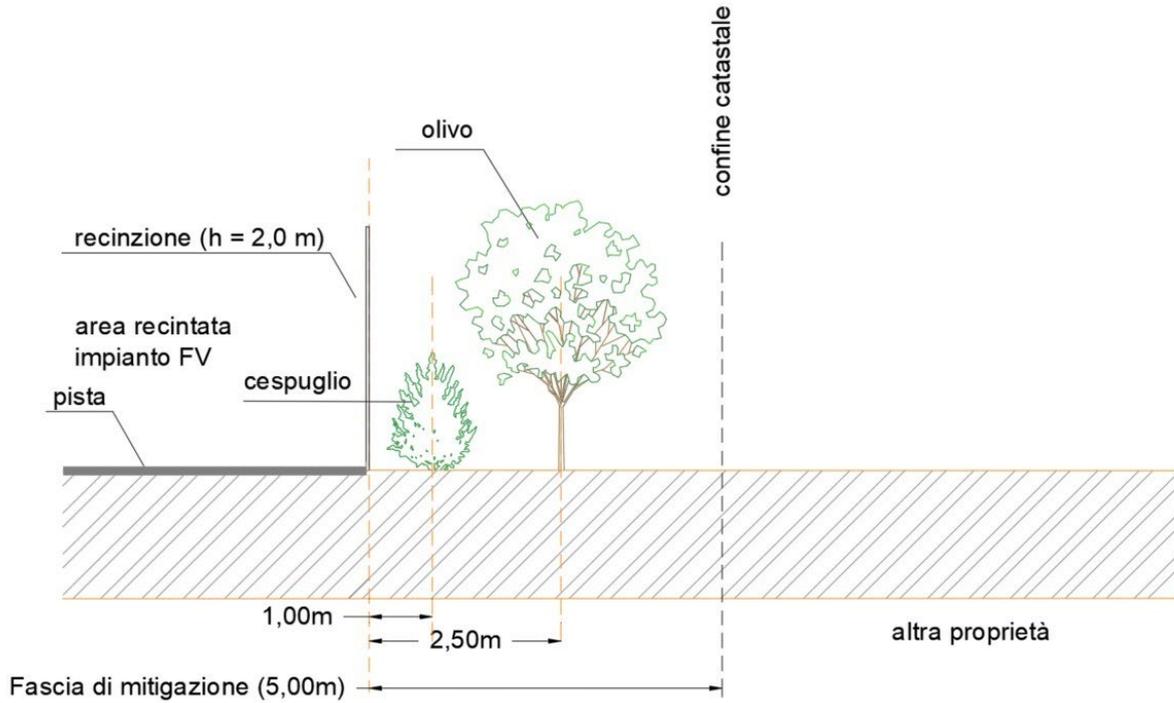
Stralcio di sezione dell'area perimetrale dell'impianto.
